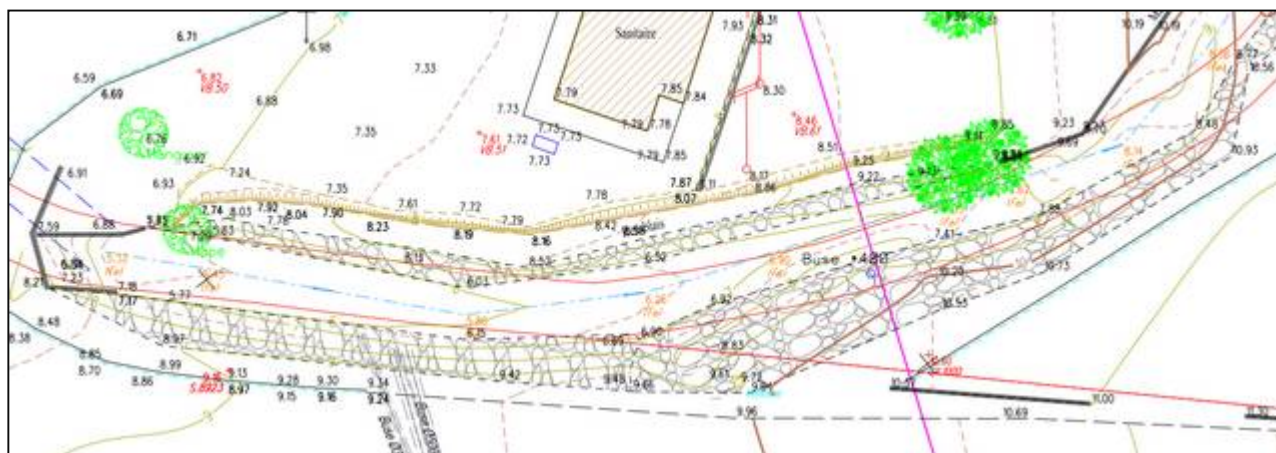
Section en amont de l'ouvrage de la RDC, planche 2, topographie de 2019
